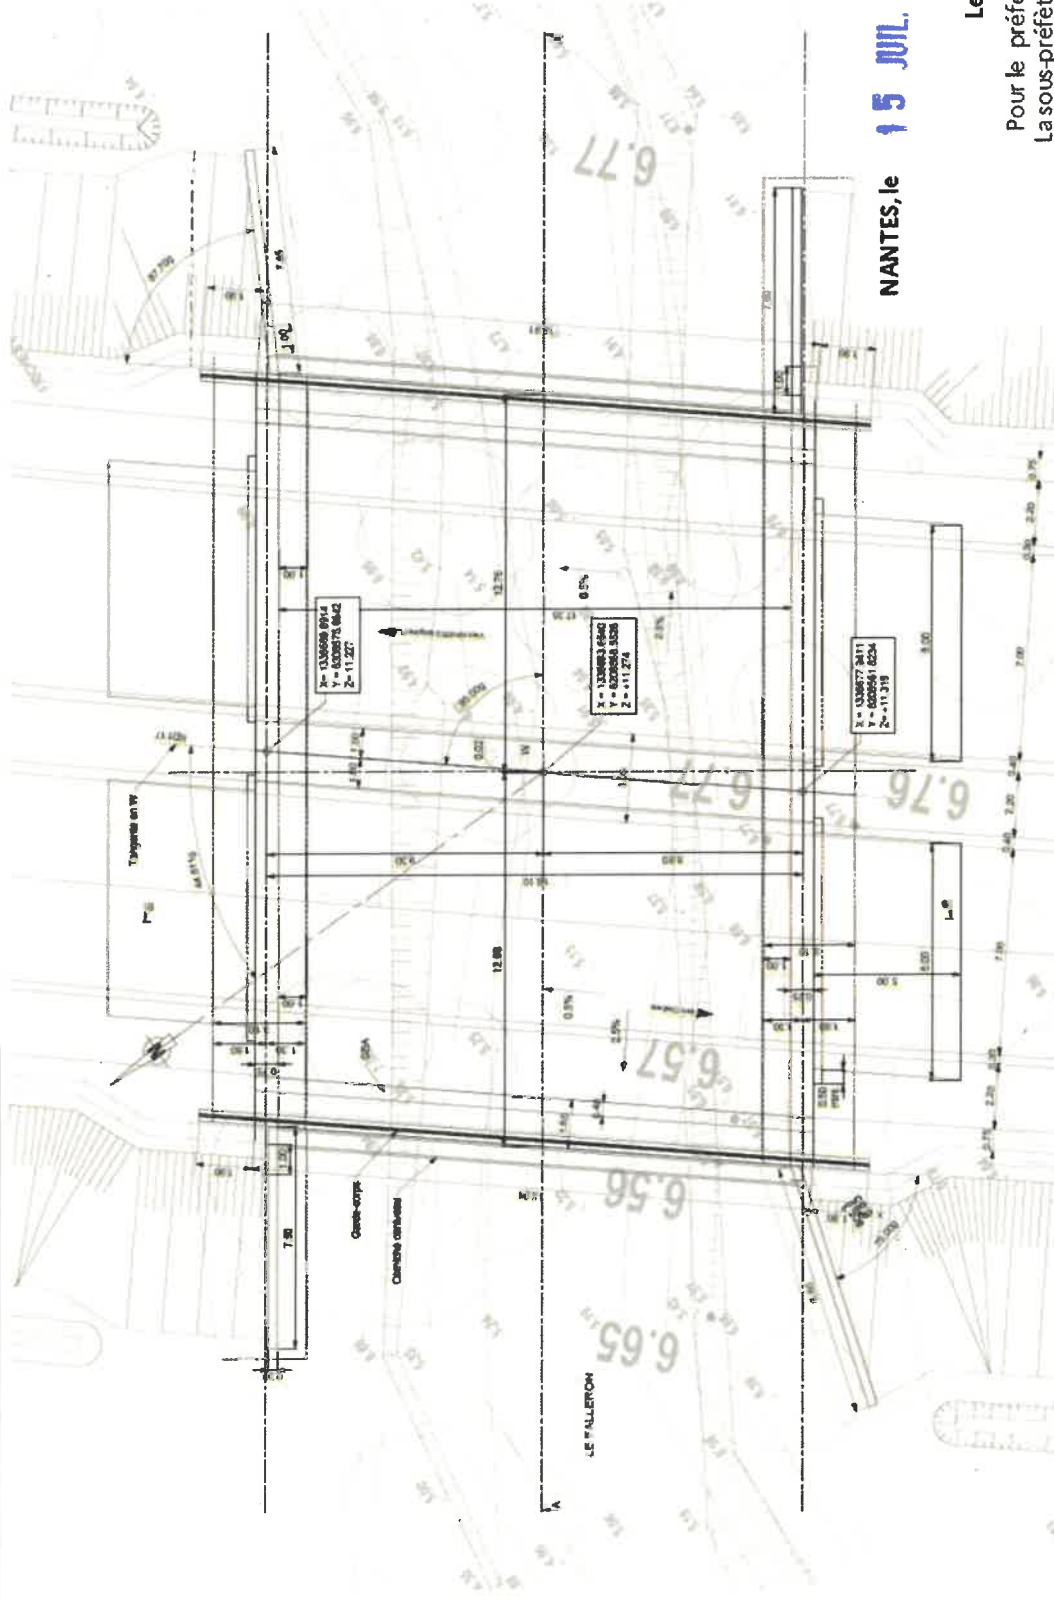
Vue en plan de l'ouvrage du Falleron - configuration 2x2 voies
